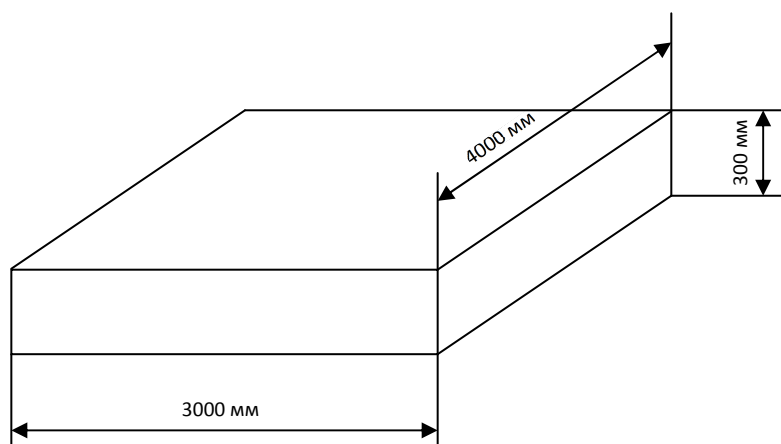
Бетонируемая конструкция: плоский фундамент
